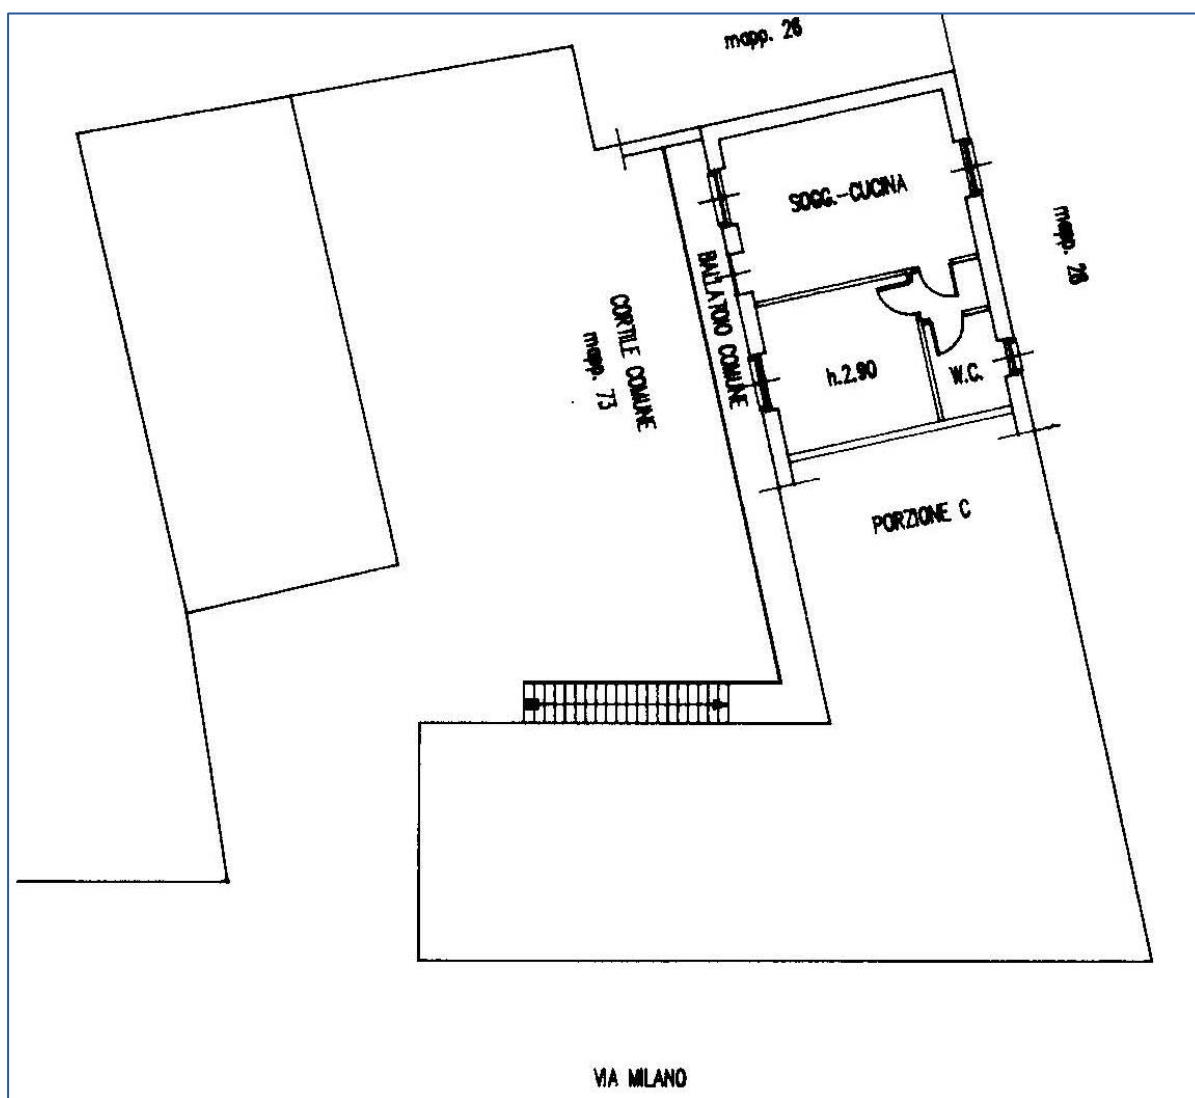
Estratto planimetria catastale Corpo A - Appartamento
